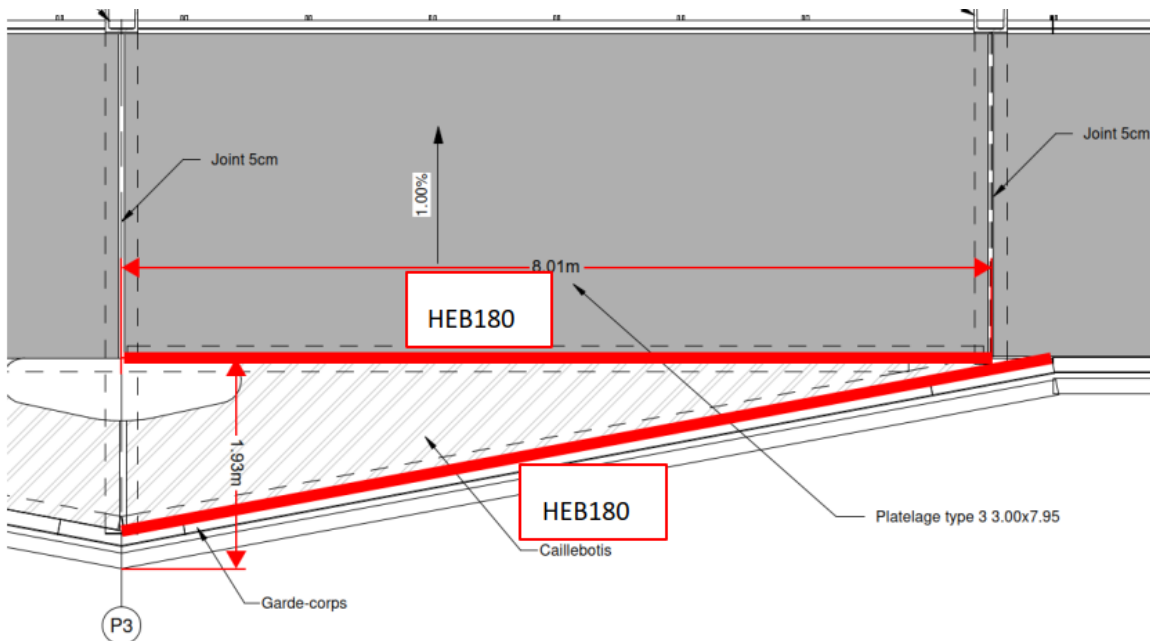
Extrait cahier de plan – Vue en plan platelage belvédère
